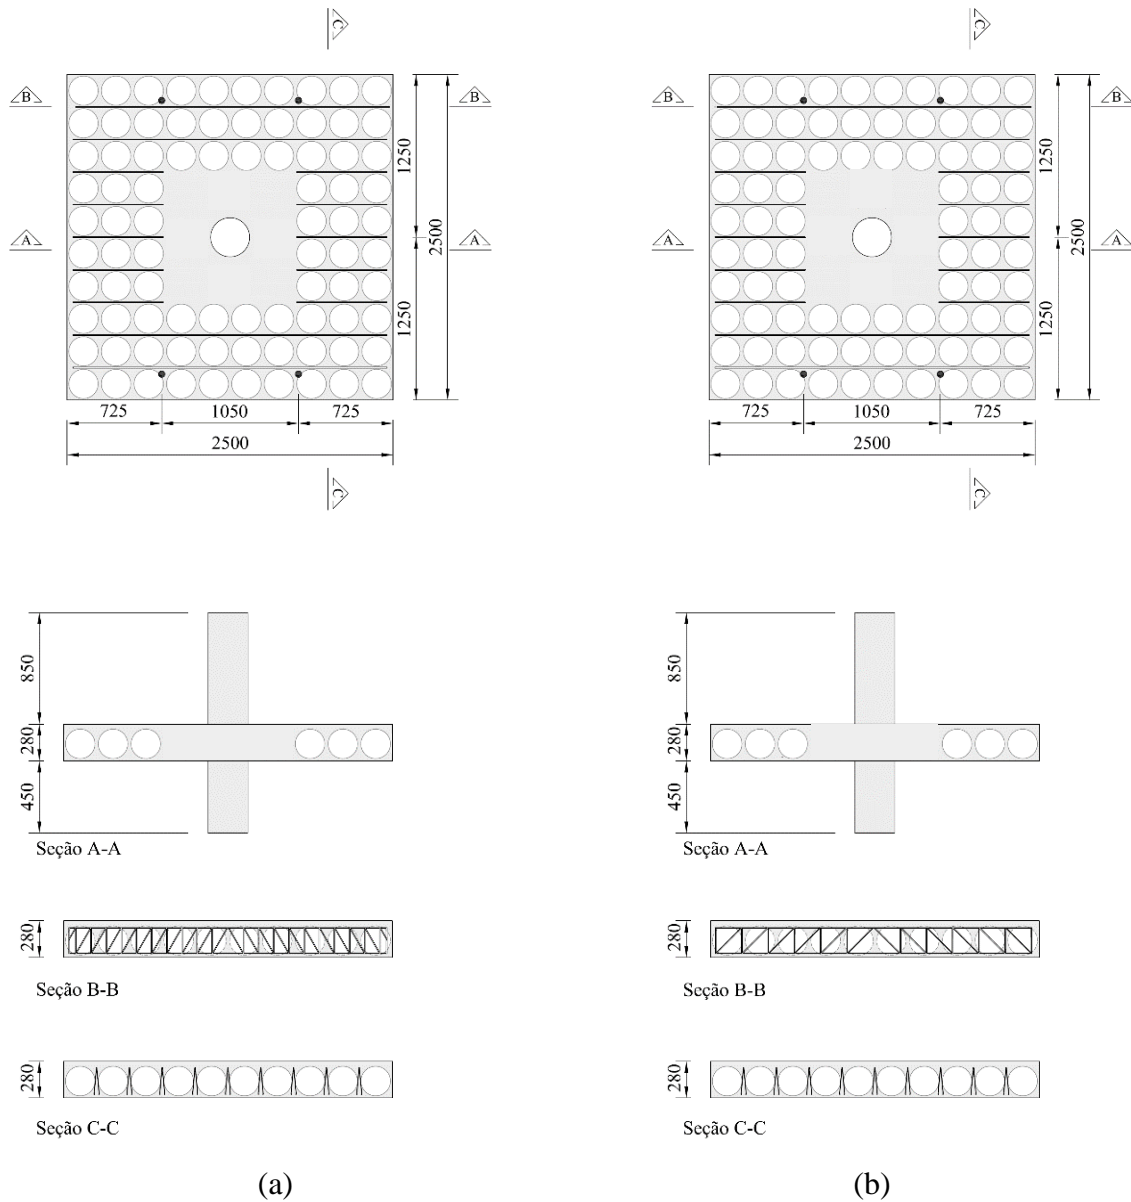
Planta e cortes das lajes (a) BD-A04 (b) BD-A05.
